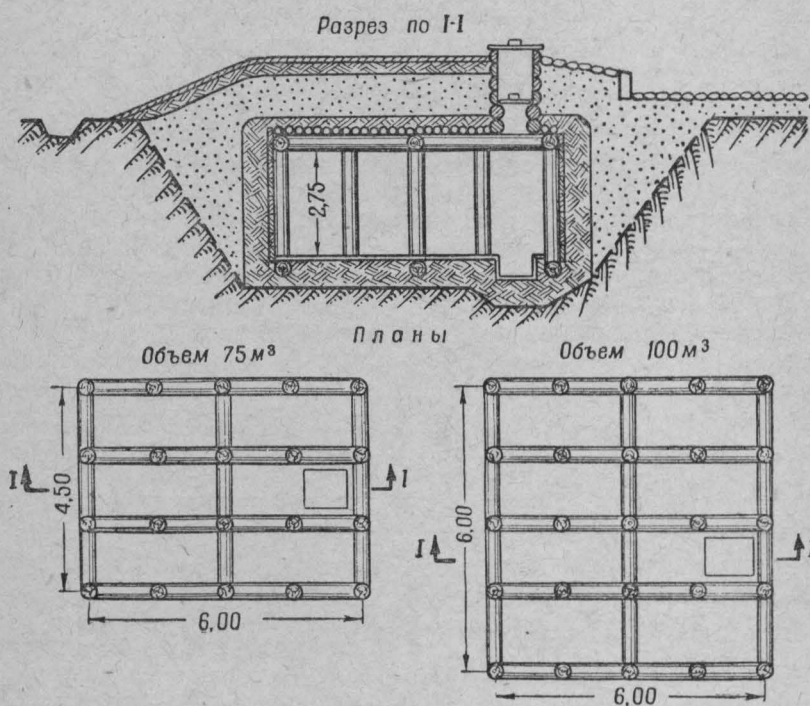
Деревянные водоемы с каркасными стенами (объем 75 и 100 м³)
